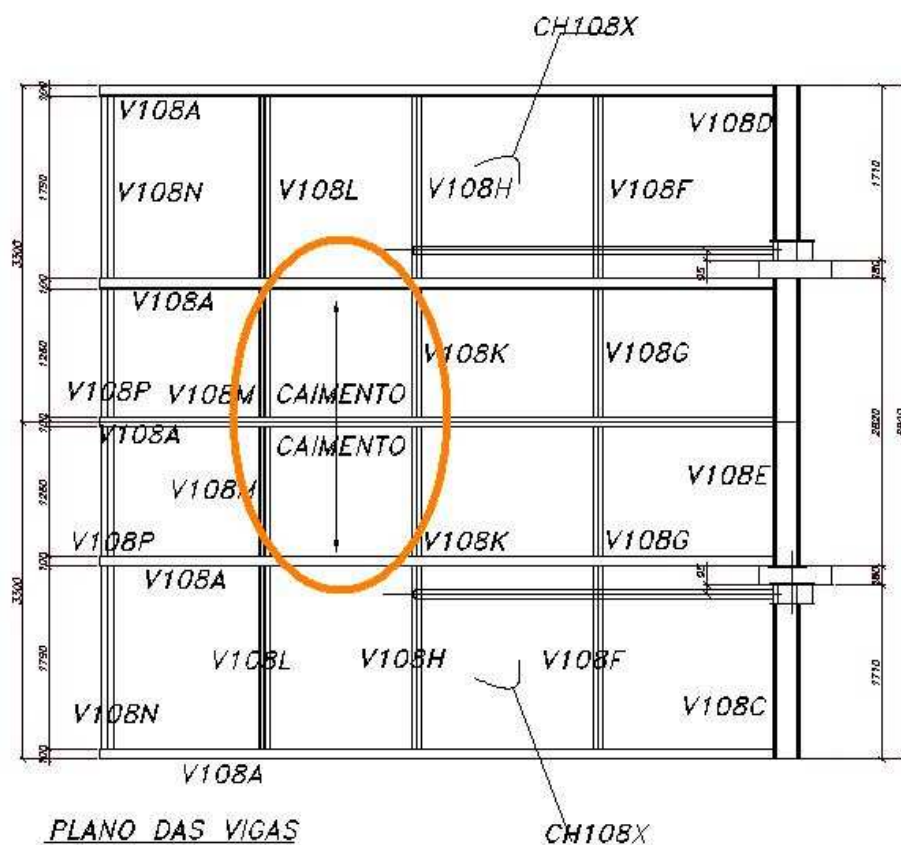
Plano das vigas da Marquise (CEPLAN/UnB, 2009)
